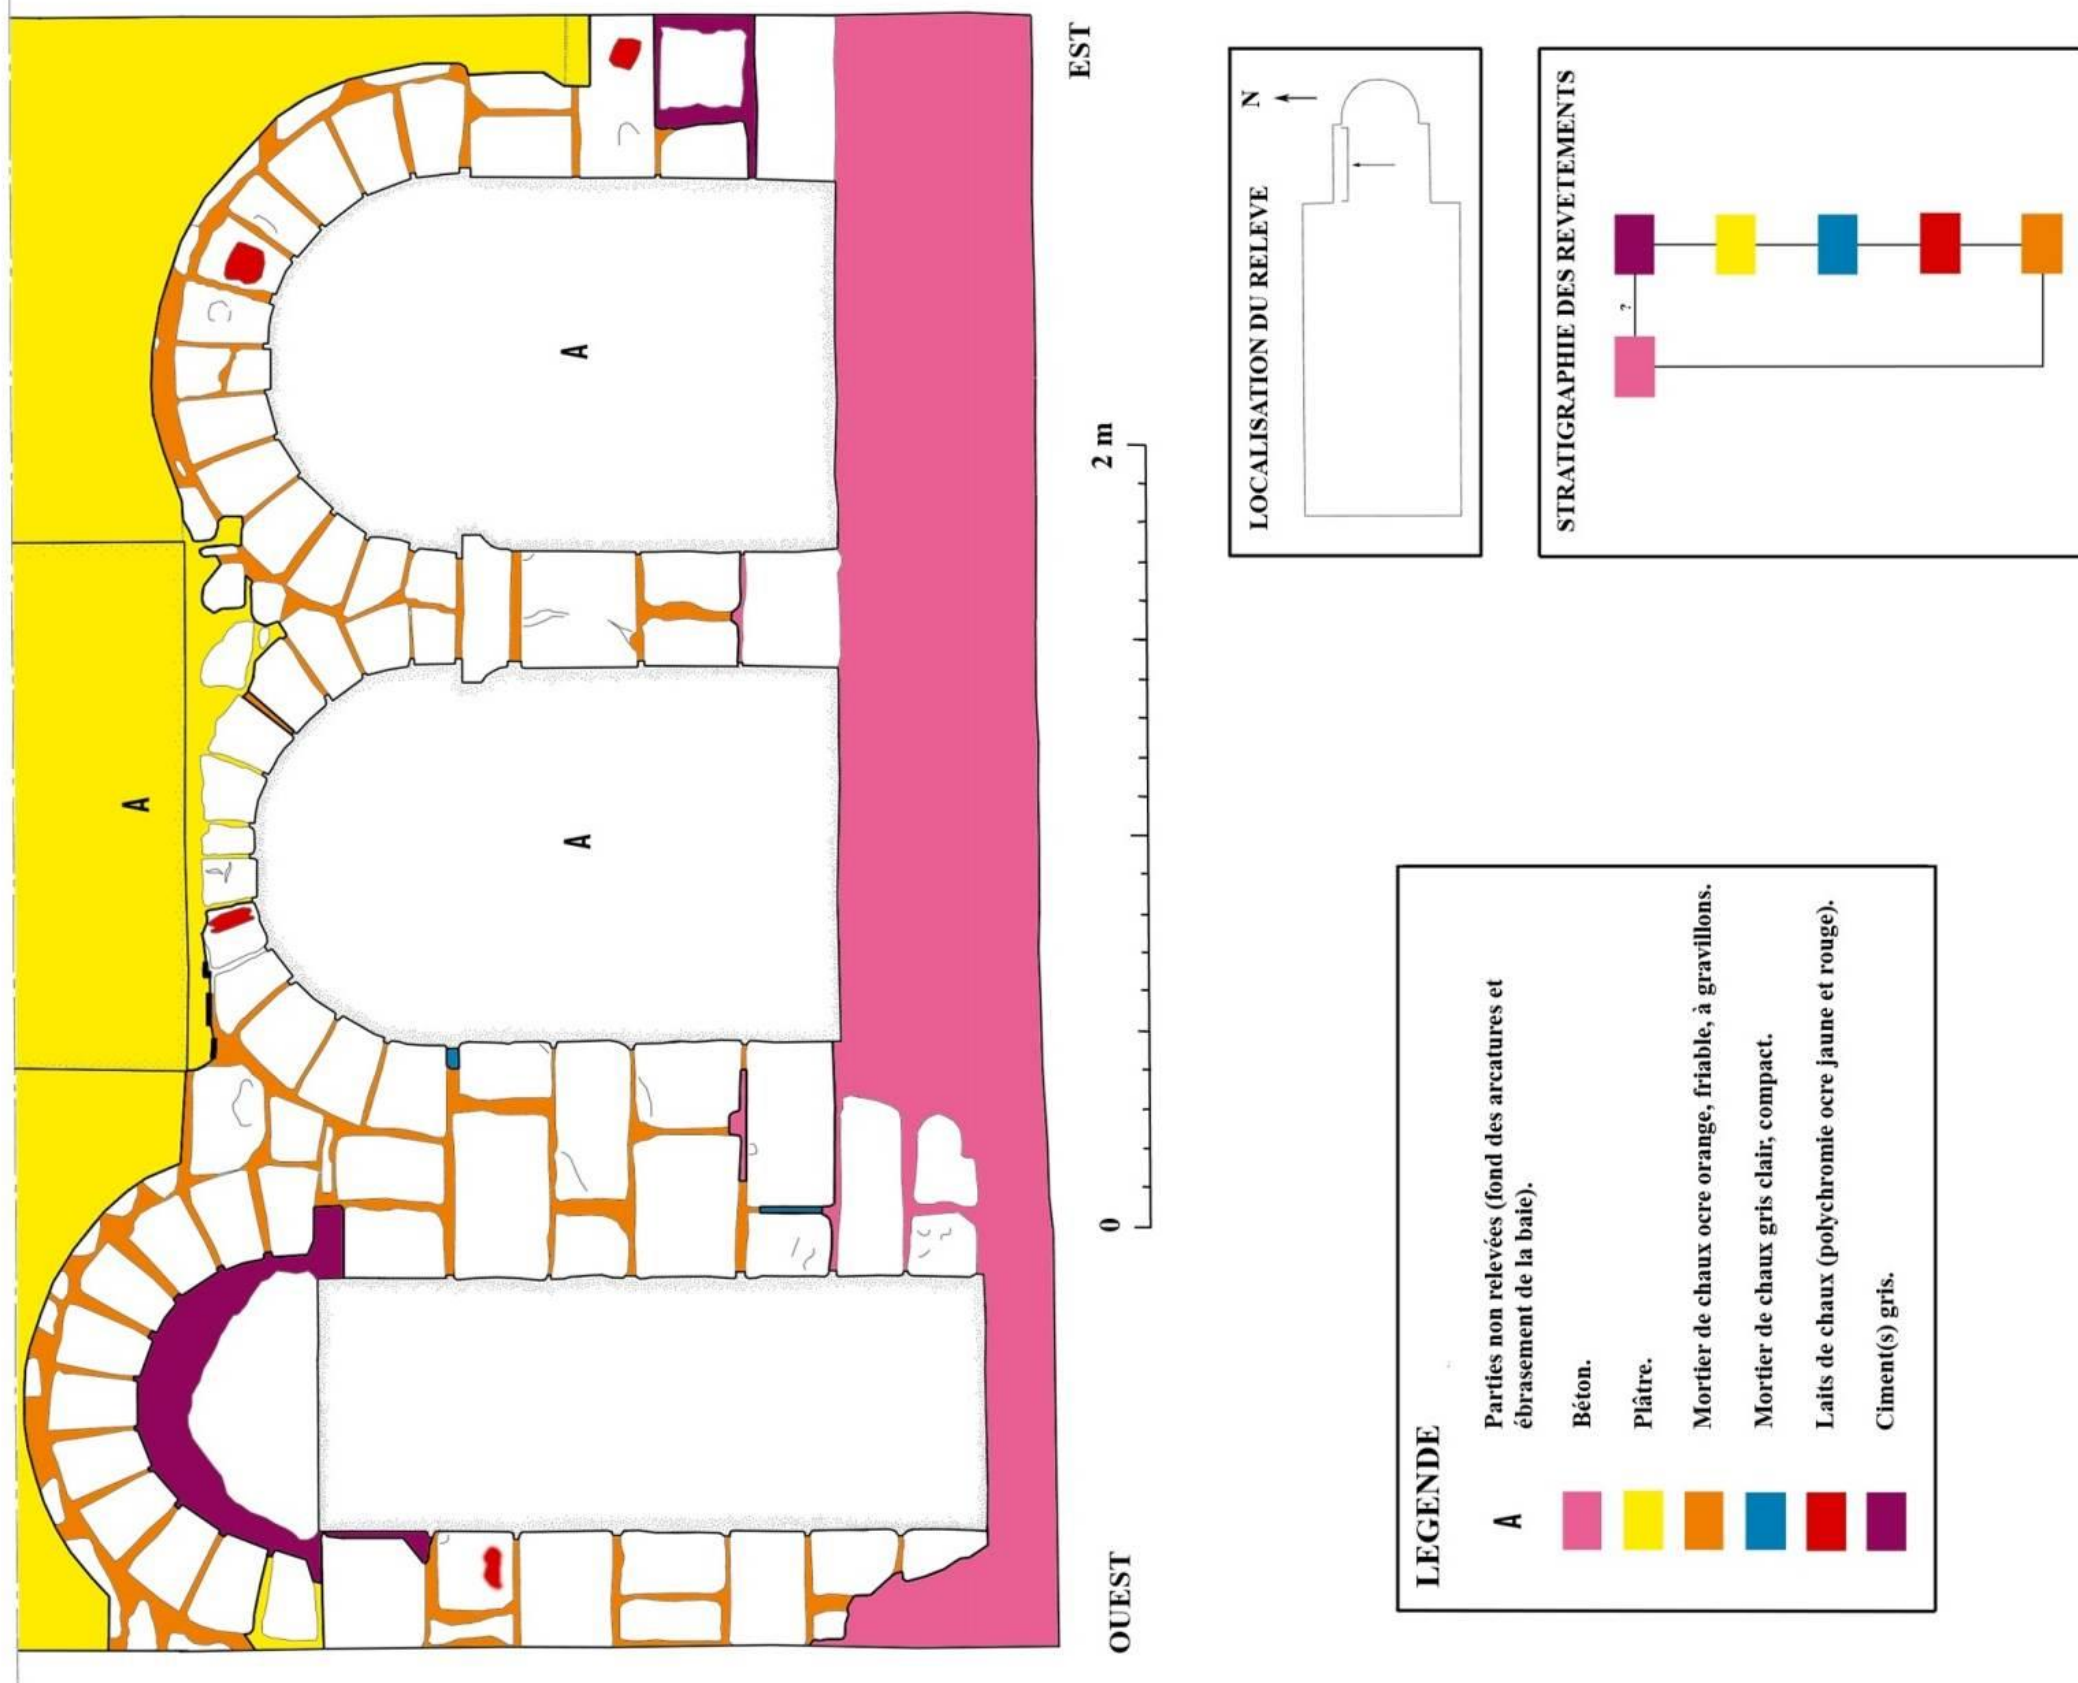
Relevé pierre à pierre du mur nord de la travée droite du chœur, avec indications des revêtements.
